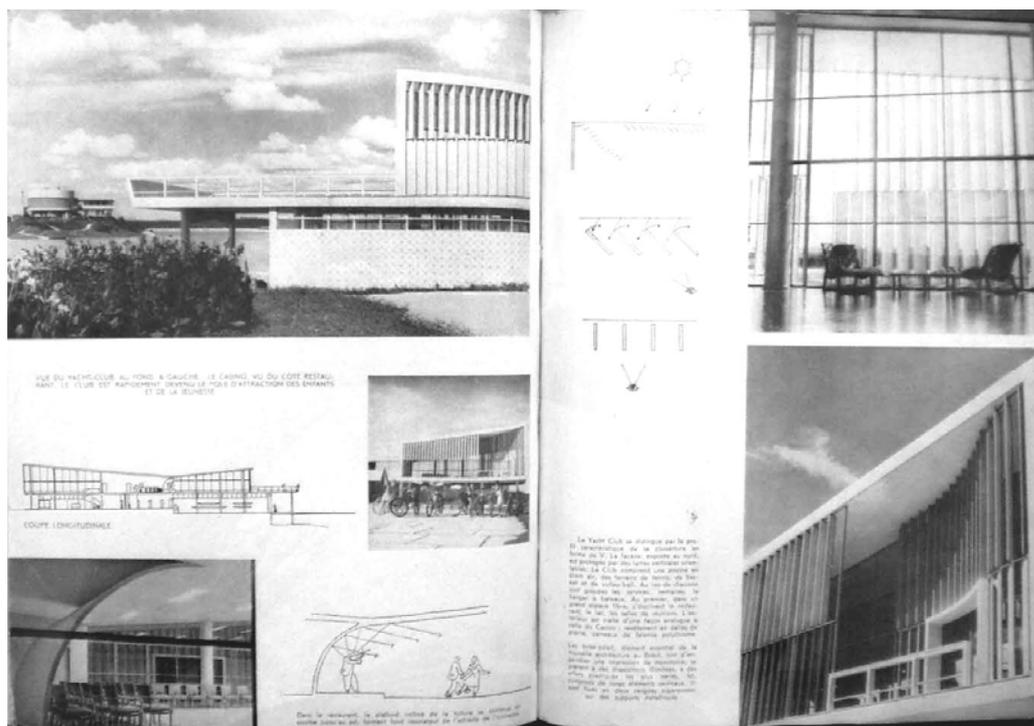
Vista do Iate Clube ao fundo à esquerda, o Cassino visto do lado do restaurante; Corte longitudinal; *Brise-soleil* da fachada. No interior do restaurante teto inclinado para acústica do palco. Desenhos mostrando a função dos *brise-soleils* (Fotos Marchand e Lyon). Fonte: *L'Architecture d'Aujourd'hui*. Número Especial, 13/14 setembro de 1947, pp.30-31
